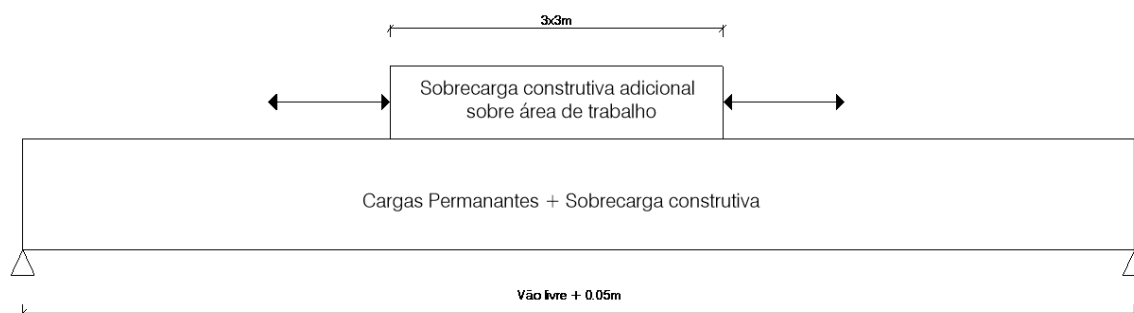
Cargas de dimensionamento para a fase construtiva.
